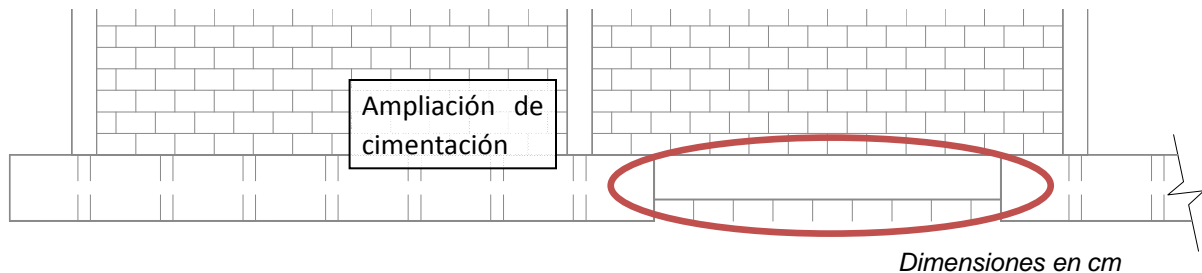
Ampliación de la viga de cimentación del muro ME6 mediante trabe apoyada en mampostería
